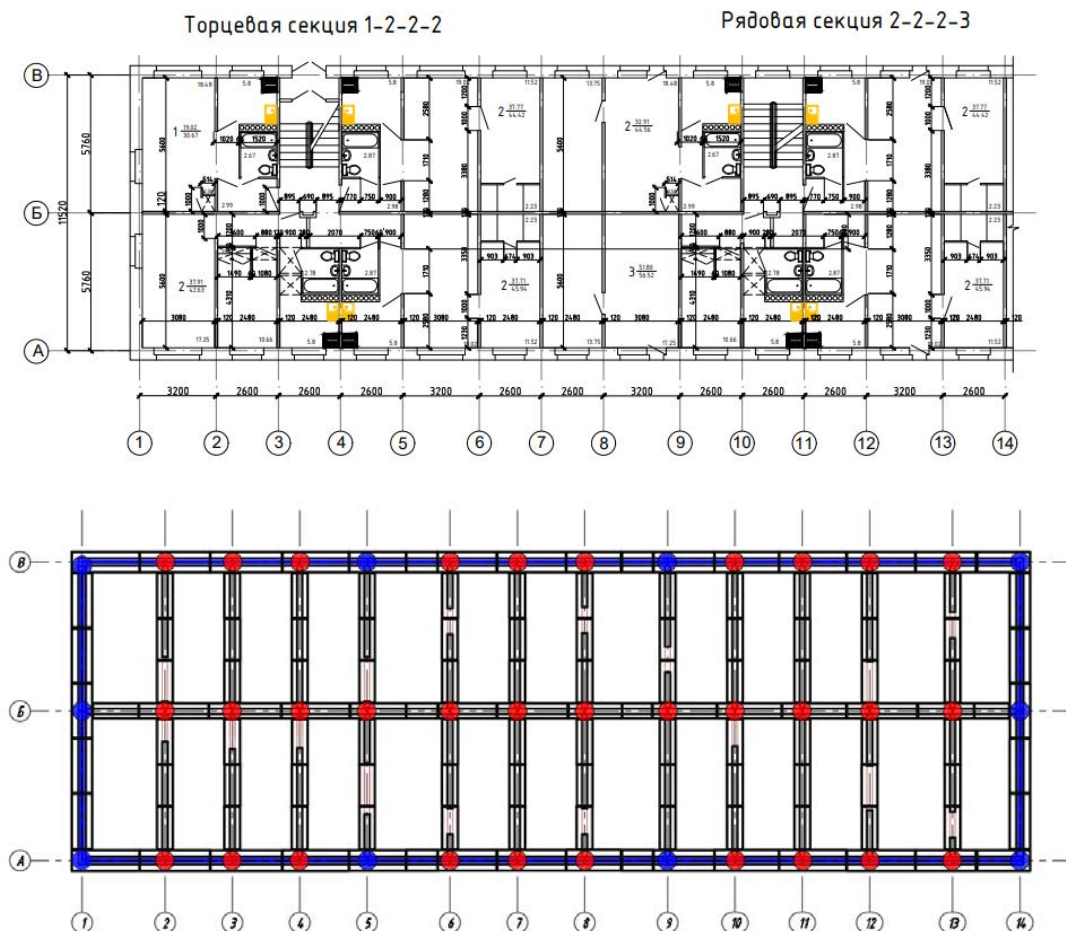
План секций, план фундаментов с расставленными резинометаллическими опорами
